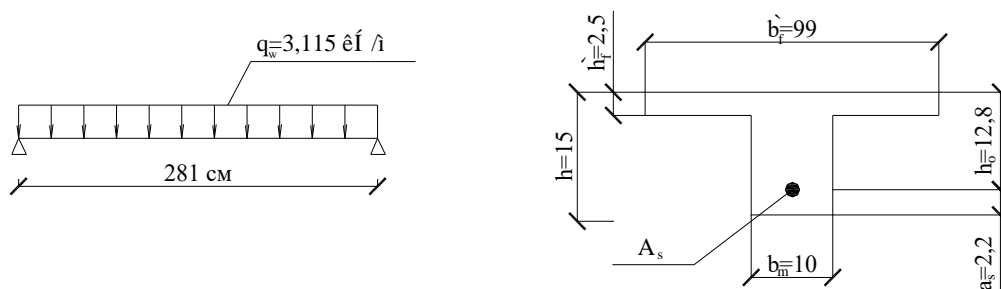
Розрахункова схема та розрахунковий поперечний переріз поперечного ребра.
